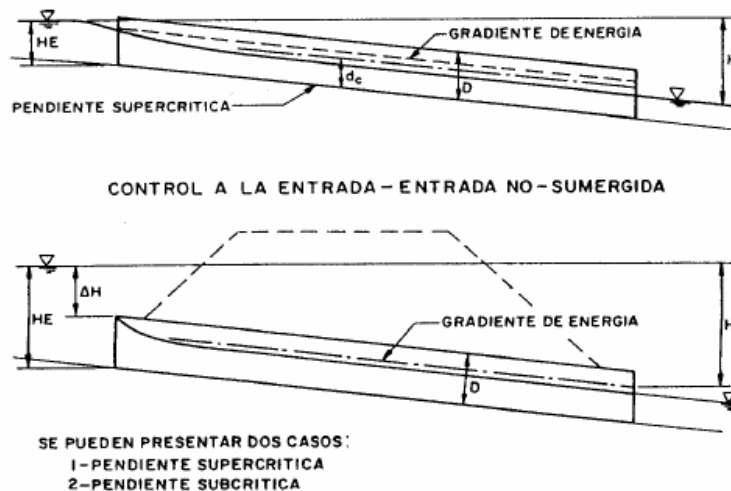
Alcantarillas con control a la entrada a) No sumergida, b) sumergida.
